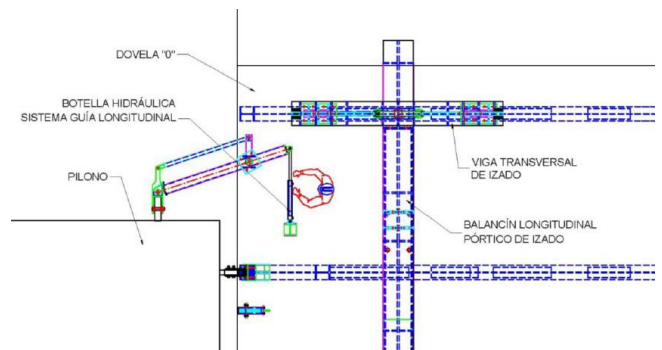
Sistema de guiado longitudinal adaptable a la pila.
